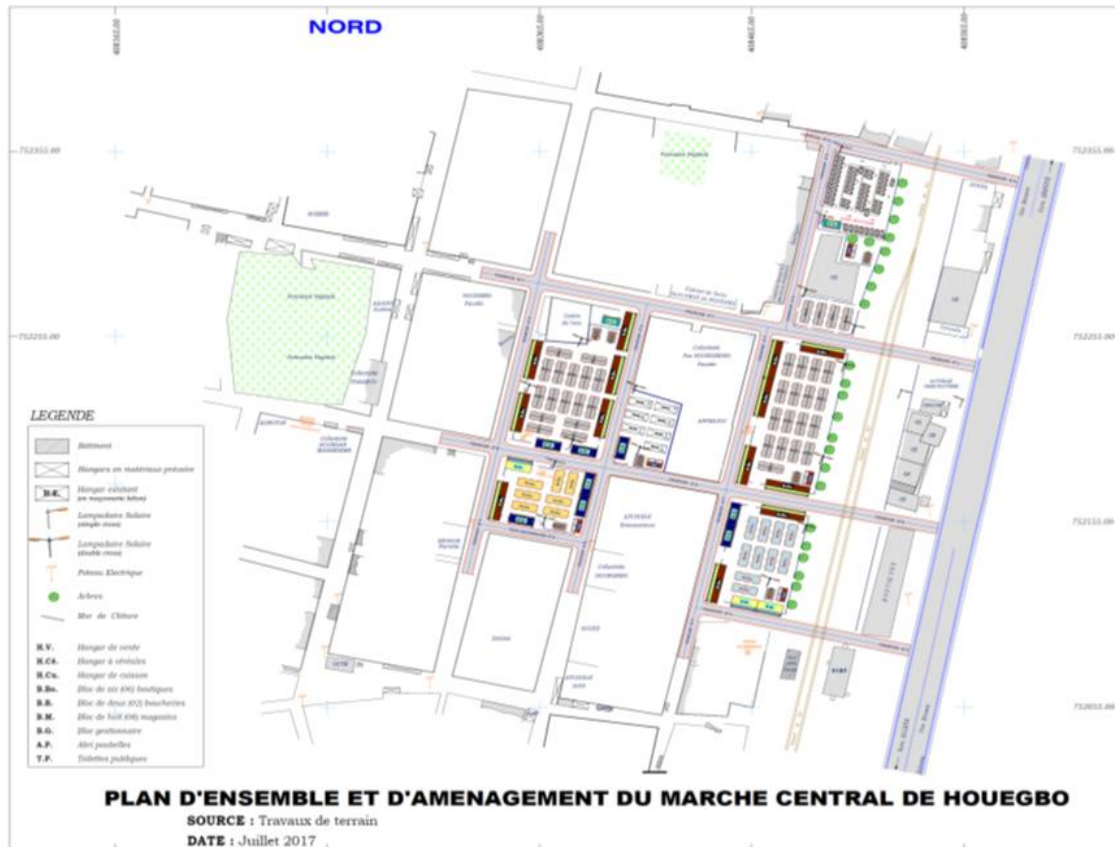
Plan d'ensemble de l'aménagement et d'assainissement du marché central de Houégbo
